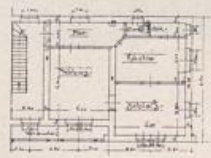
Dienstgebäude. Münsterstrasse. Obergeschoss. 1:500.
